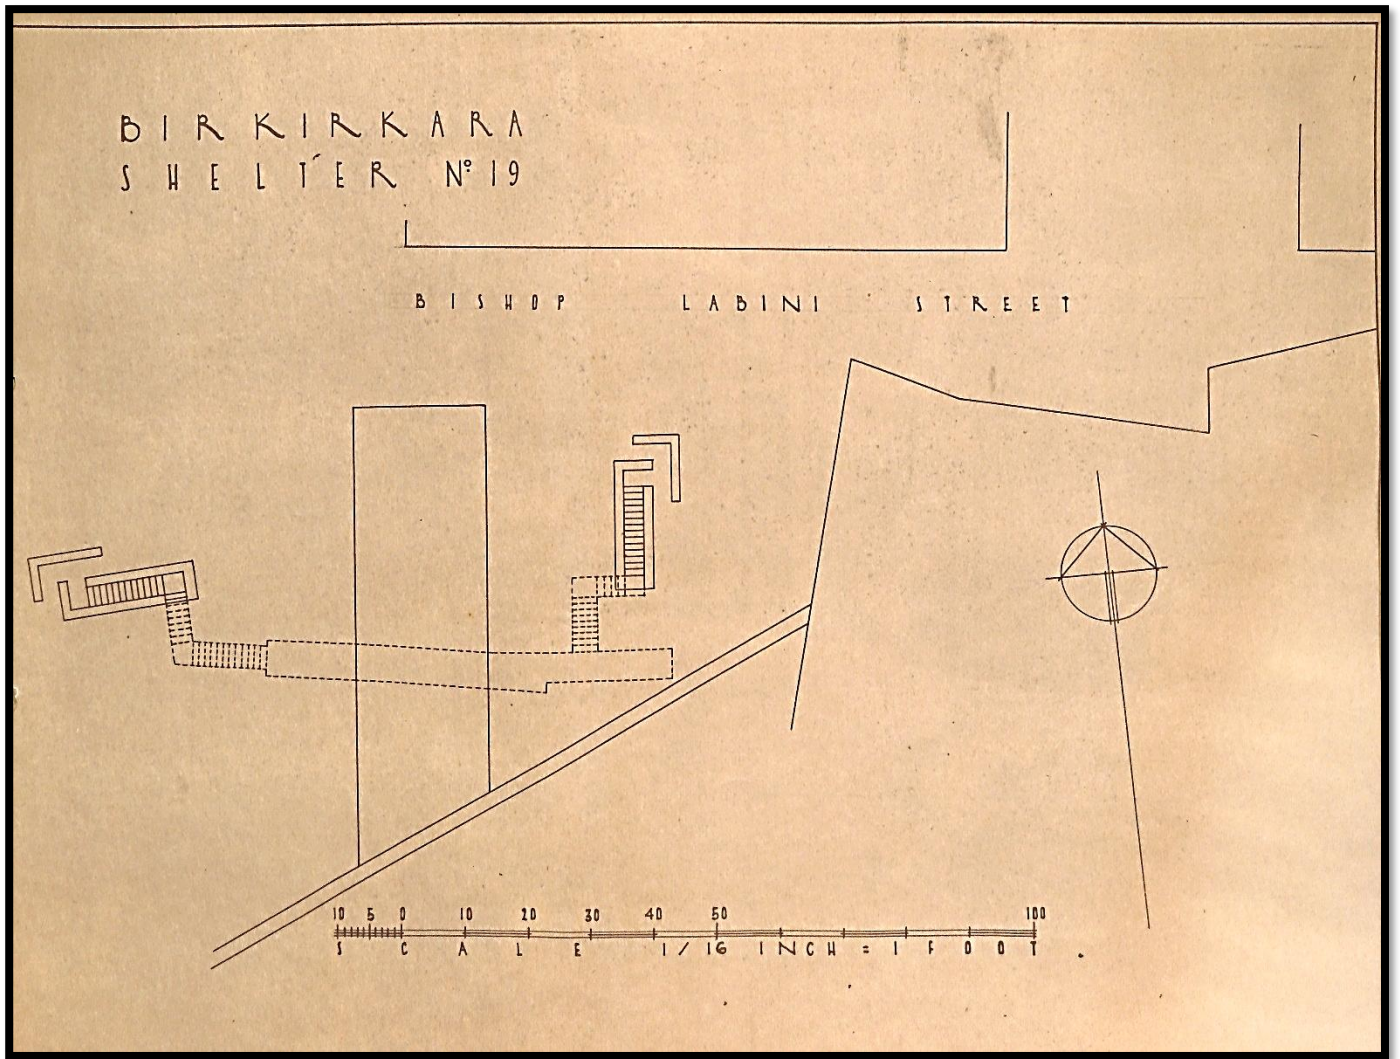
Planta do Abrigo nº 19 "Bishop Labini Street"
